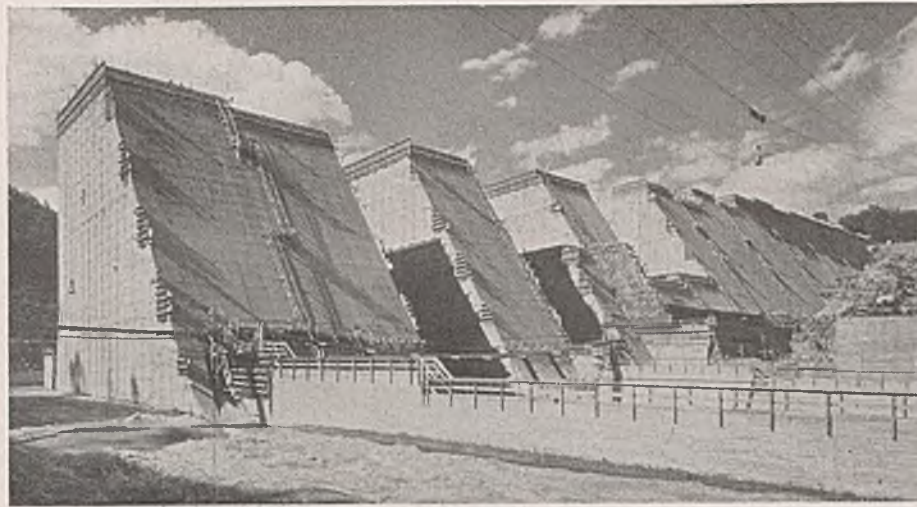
Betonierung des Norris Dam mit Gleitschalung in 17-m-Blöcken bei 1,5 m Schichthöhe.
